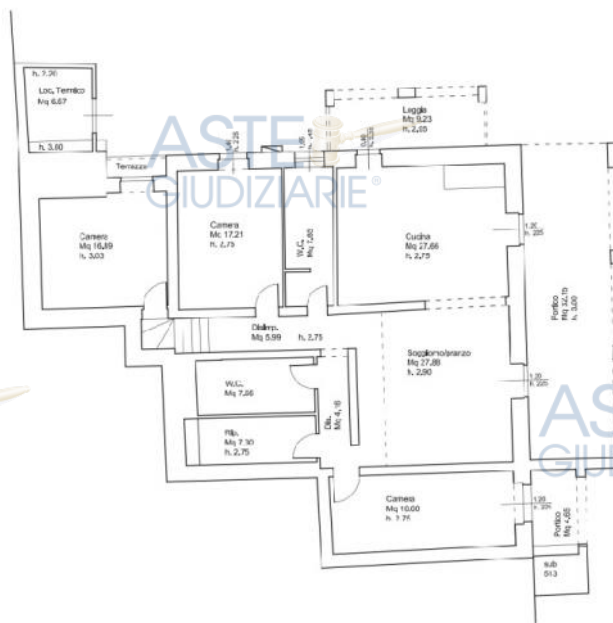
Planimetrie dello stato attuale Piano Interrato
